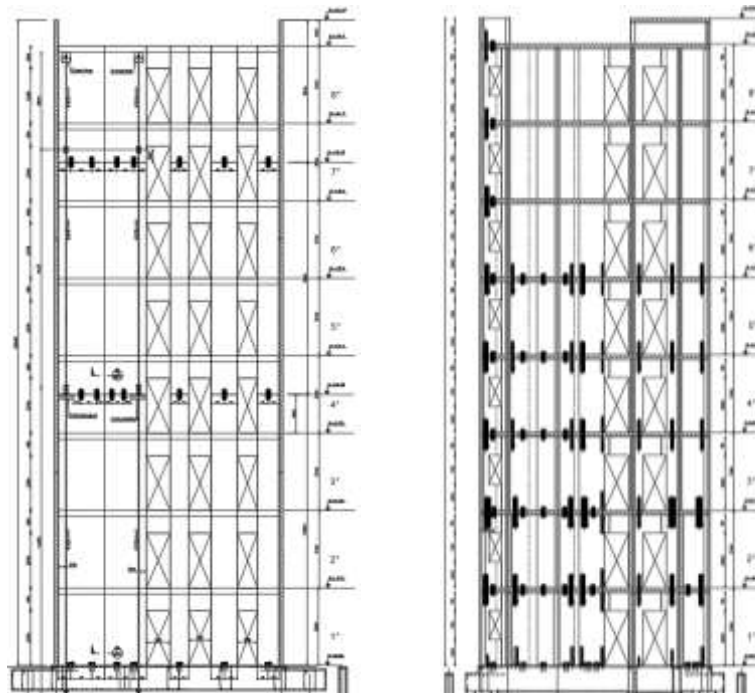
Conectores sistema constructivo Baloon y Plataforma, vista en elevación
